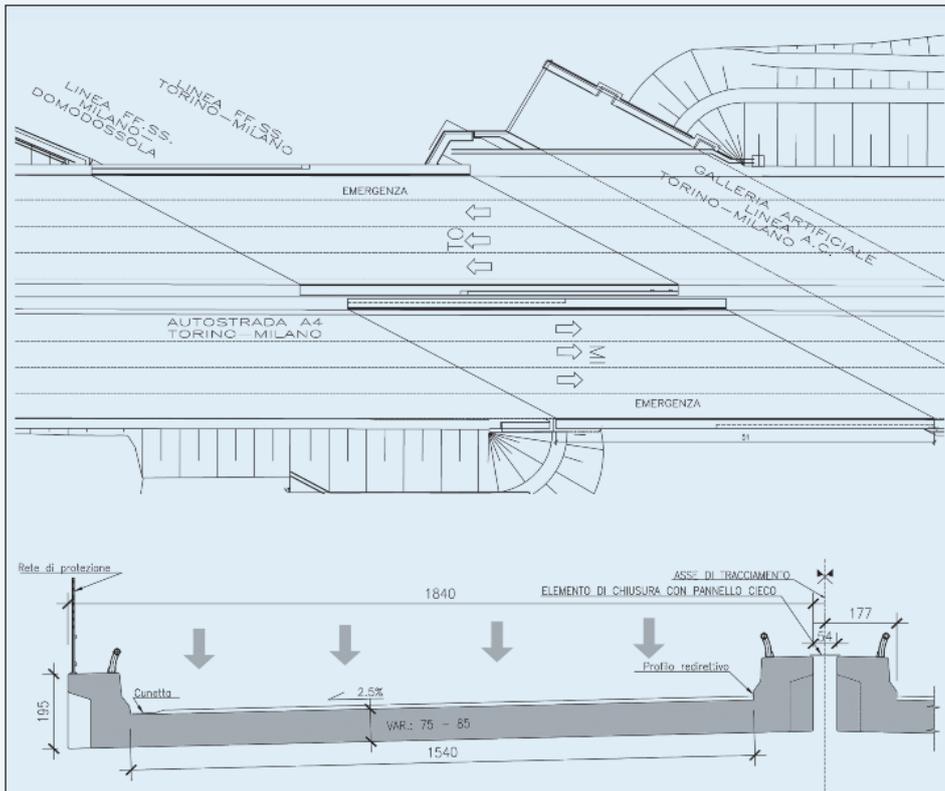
La pianta e la sezione dei solettoni di Certosa
